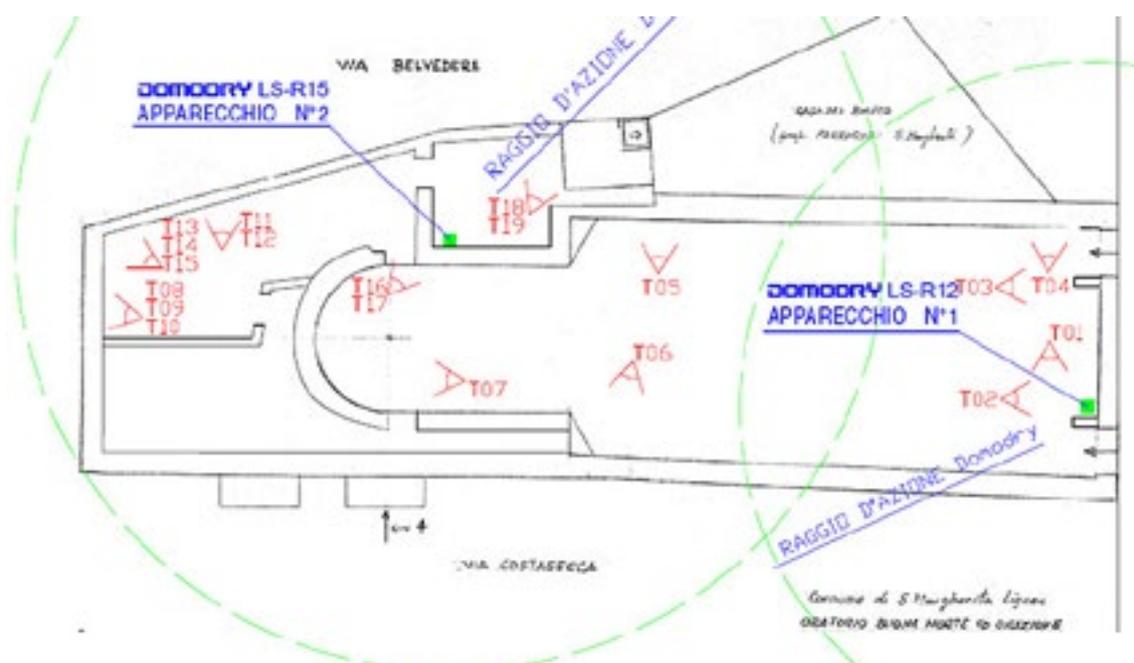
Schema dell'impianto Domodry con ubicazione in pianta delle prove effettuate (termografie all'infrarosso)
